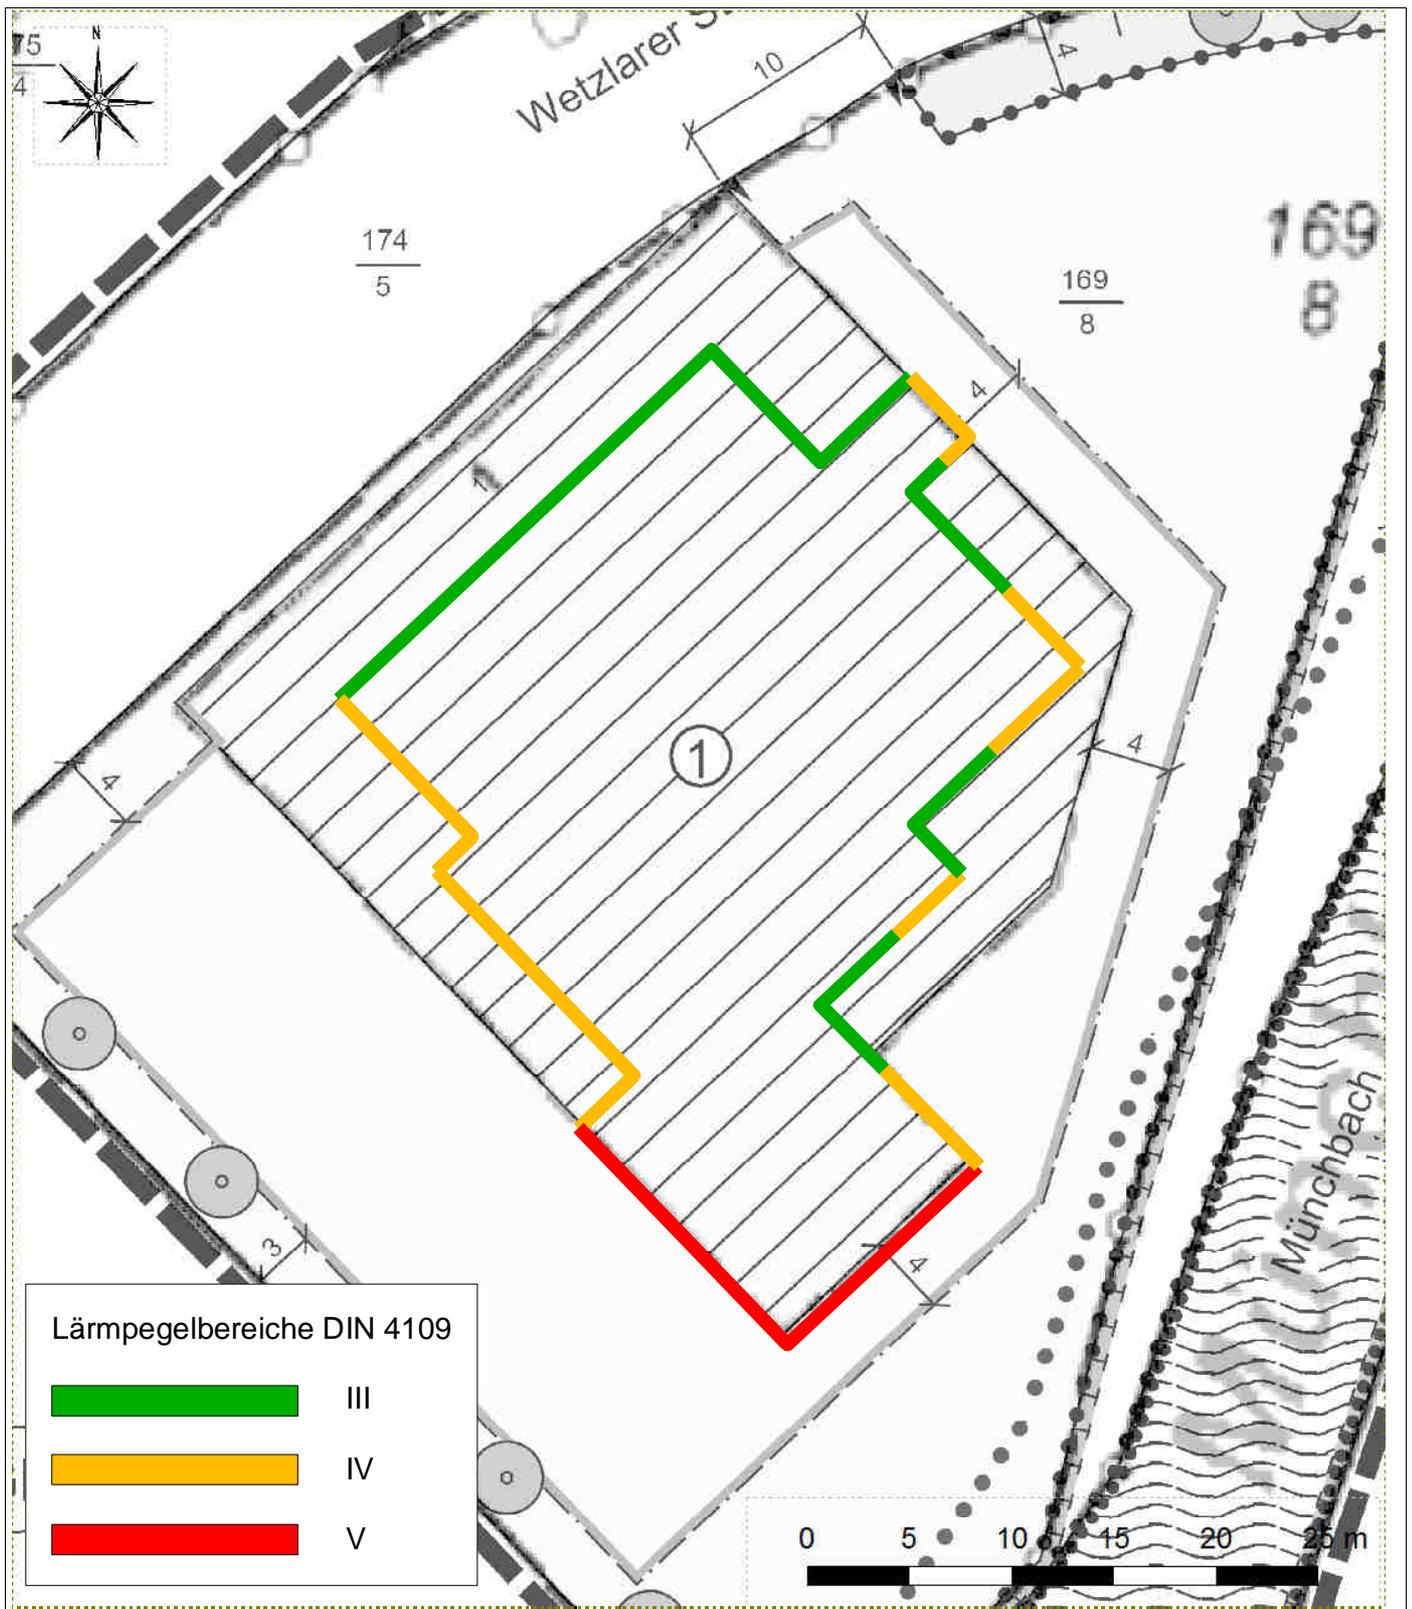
Lärmpegelbereiche Dachgeschoß.
